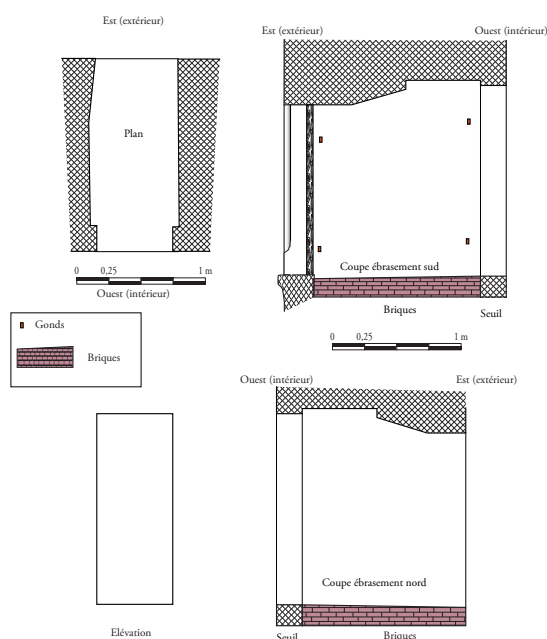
Plan et coupes de l'embrasure (UM4-3-UC2)
